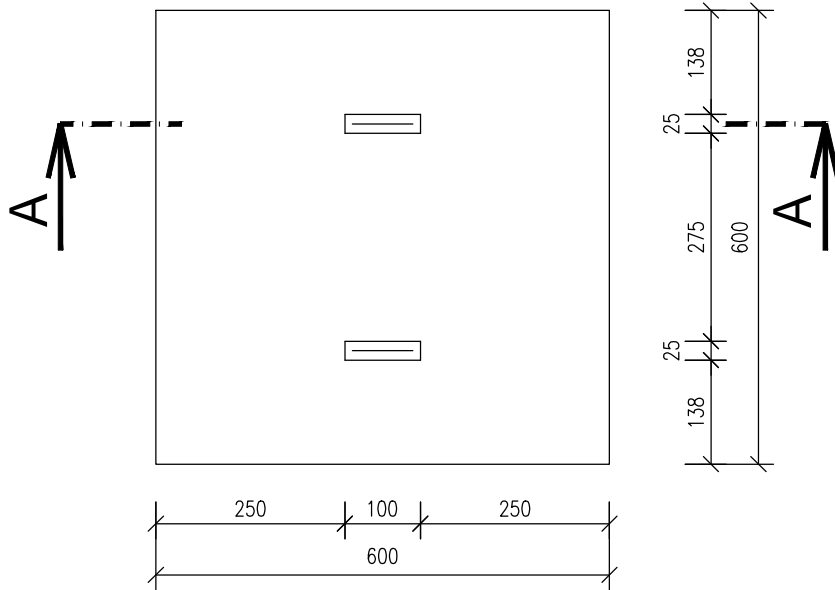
DETAIL ÚPRAVY SCHODIŠŤOVÝCH STUPŇŮ
